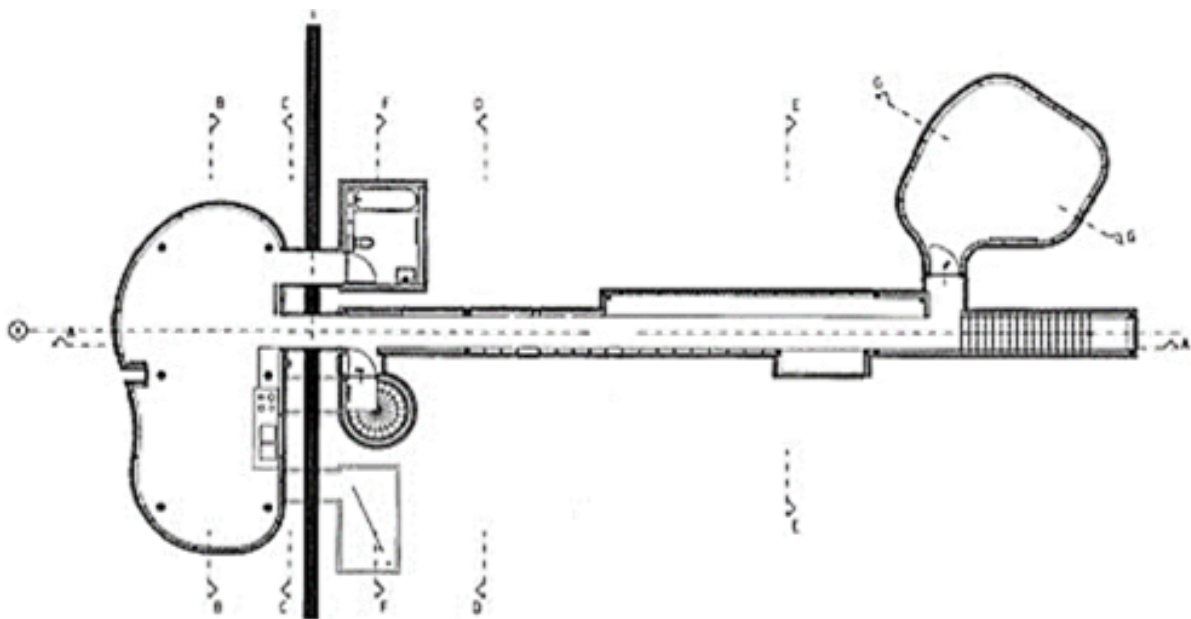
« Wall House 2 » de John Hejduk (1967)
